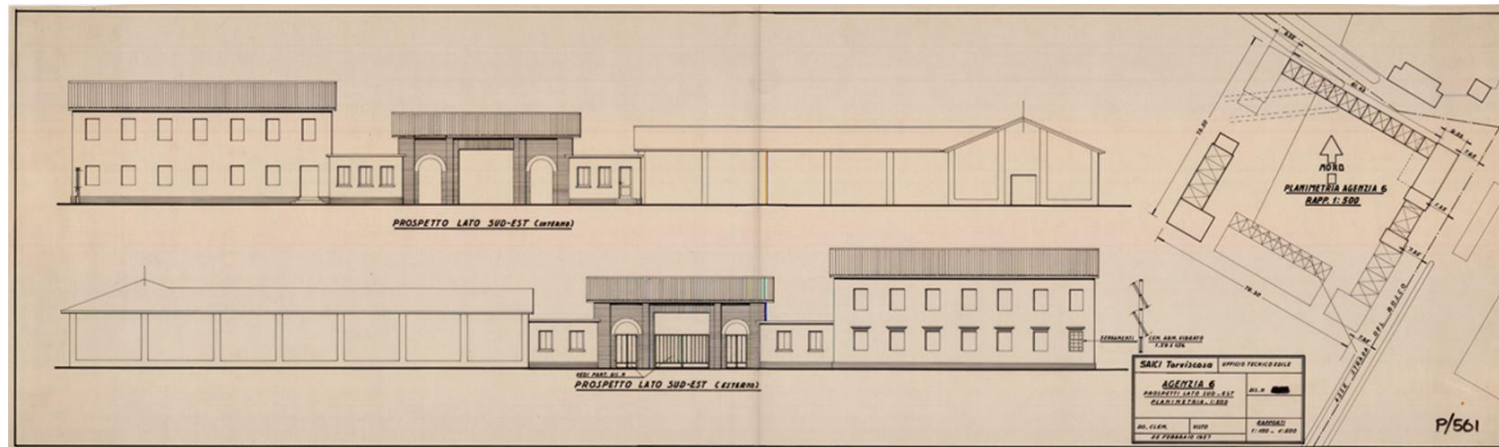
Agenzia 6. Prospetto lato sud-est lato interno e prospetto sud est lato esterno.
